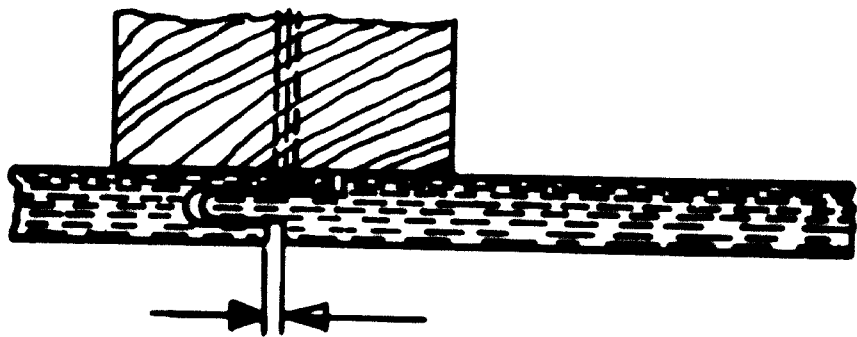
Figura IX. Detalles de construcción para el soporte de elementos de tableros de fibra
